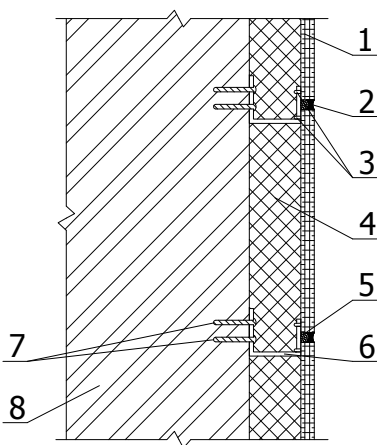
Конструктивное решение способа утепления «вентилируемый фасад»:
